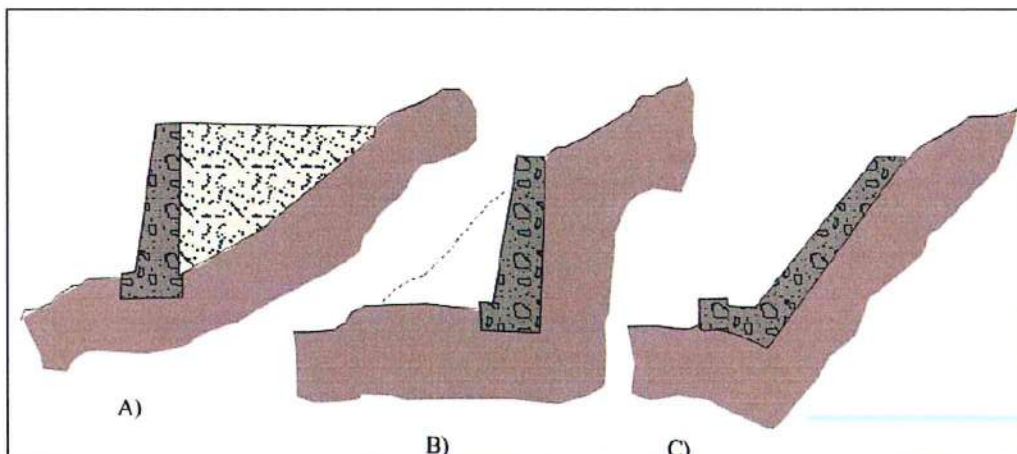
a) Muro de sostenimiento b) Muro de contención c) Muro de revestimiento.
